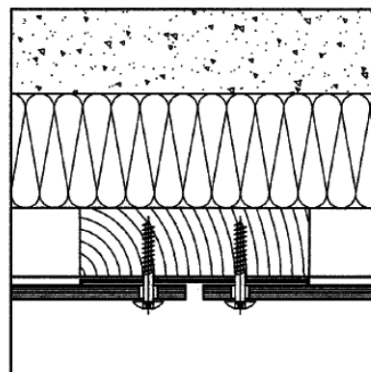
Angle extérieur (vue en coupe horizontale)
